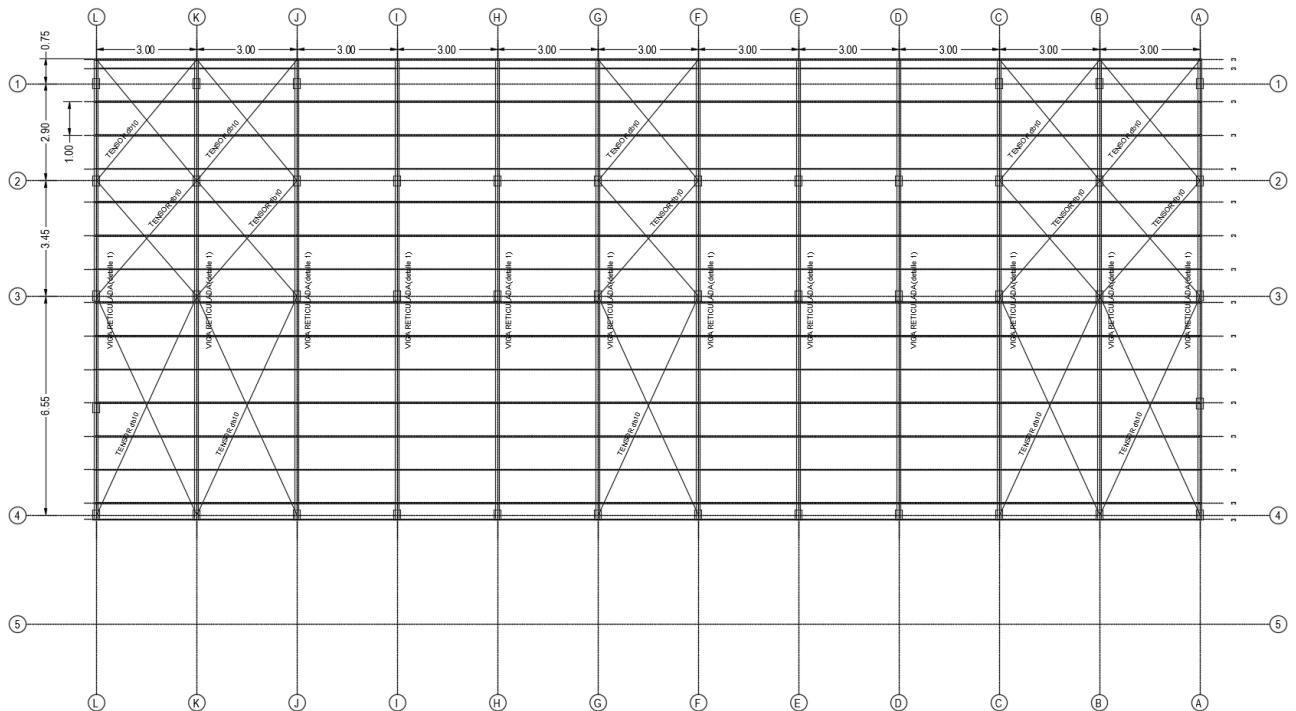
ESTRUCTURA DE CUBIERTA | LAYOUT
